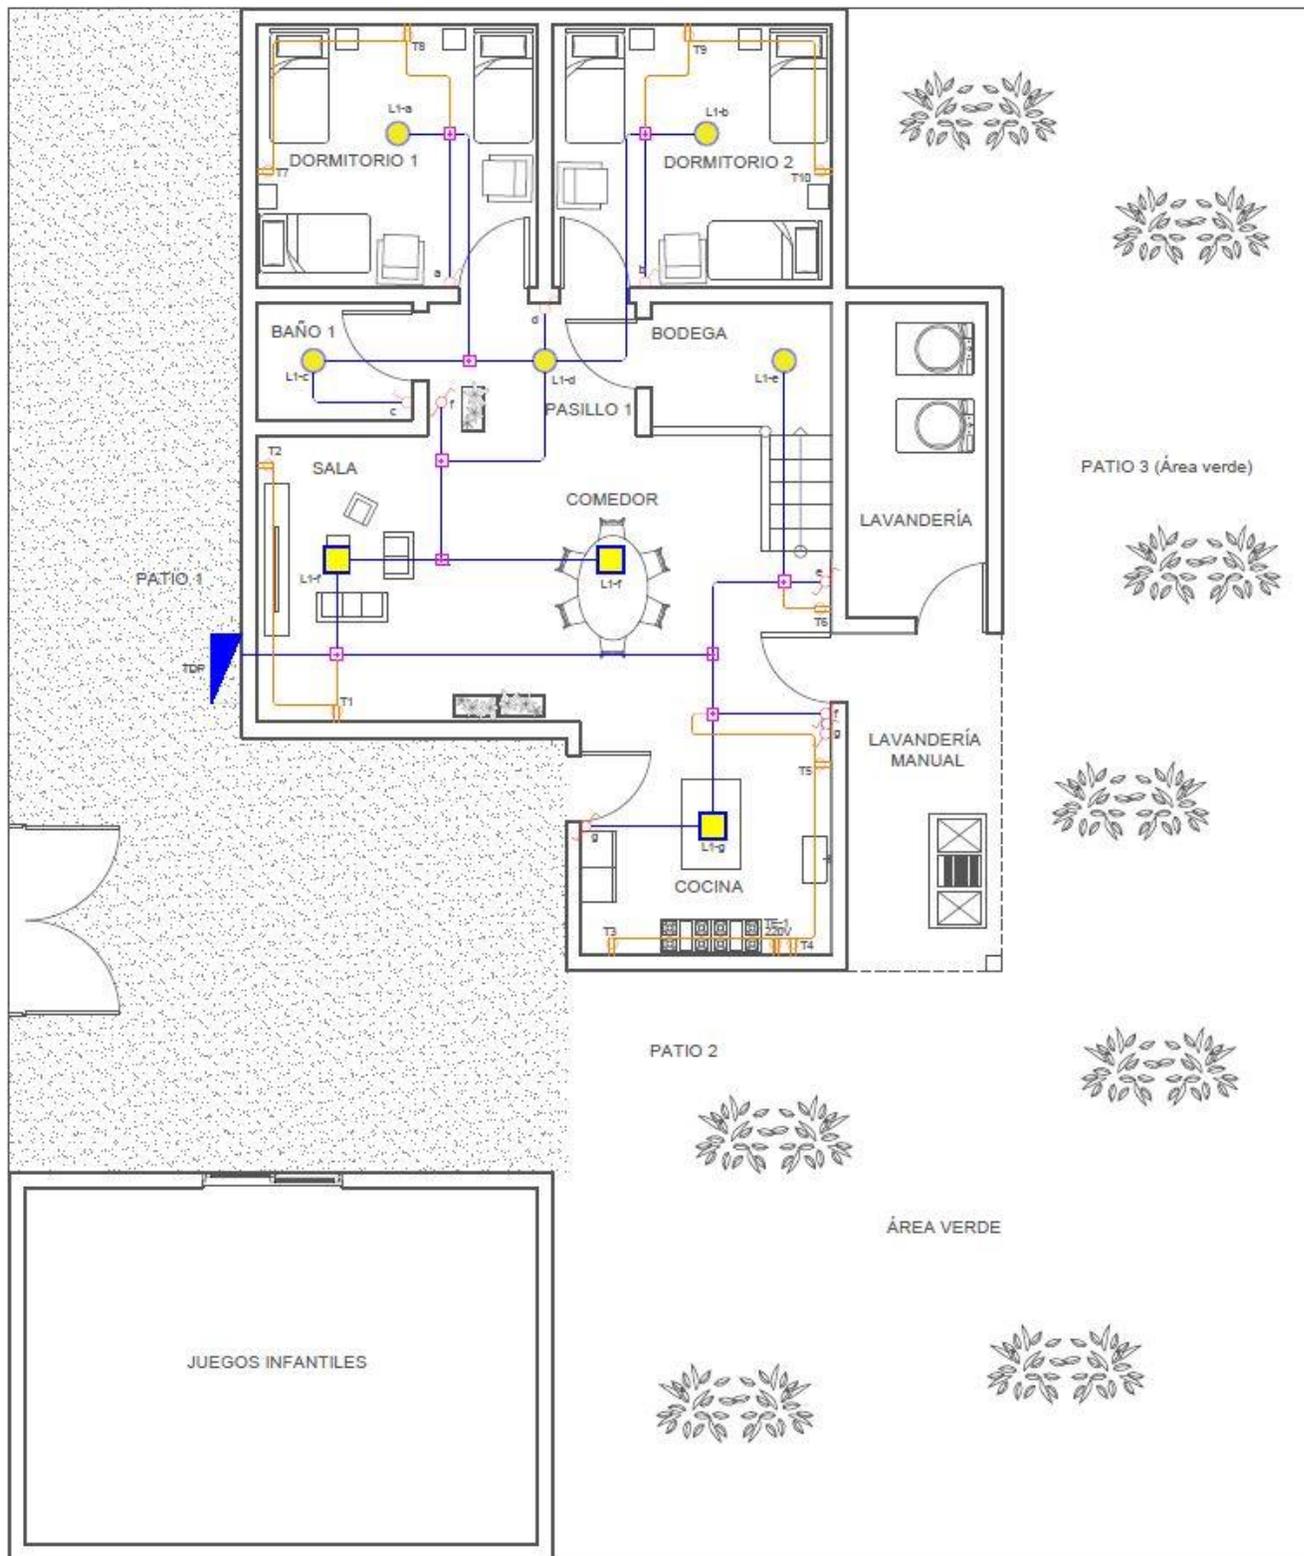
Plano eléctrico inicial planta baja o nivel 1
